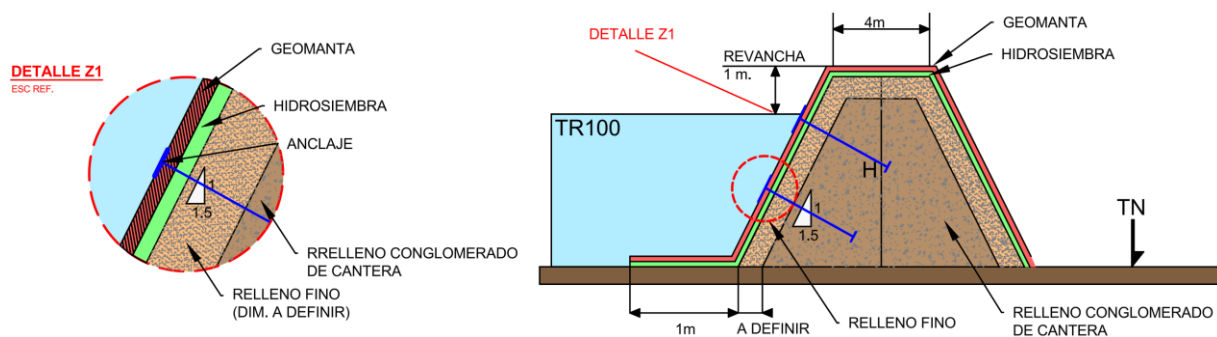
Perfil tipo de un terraplén con protección de manta de refuerzo vegetal.
